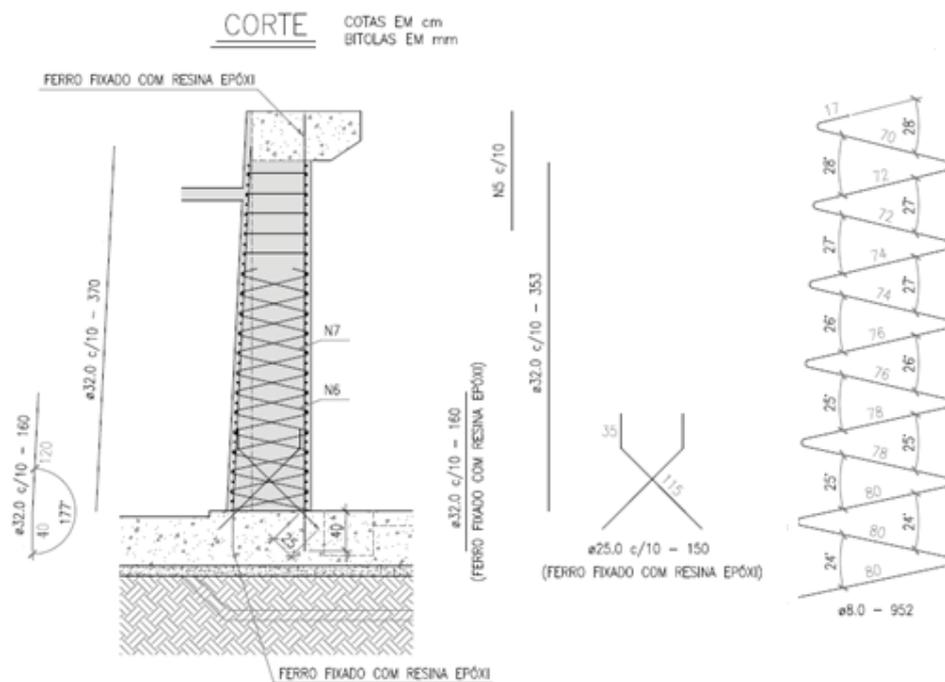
Corte de uma parede de concreto armado da oficina, apresentado no Projeto Executivo de estruturas, incluindo os detalhes das barras helicoidais e diagonais.
